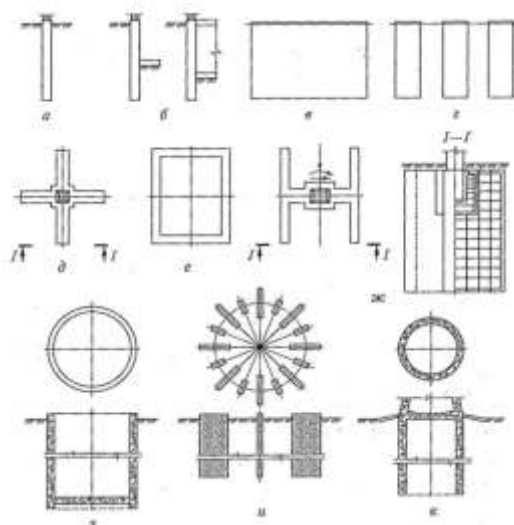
Шлицевые фундаменты: а-ленточный под стены; б,в-ленточные с подвалом; г-ленточные сплошные и прерывистые; д-под колонну крестообразные; е-прямоугольные; ж-под колонну тавровой или двутавровой формы; з-круглых в плане сооружений-опускного колодца; и,к-дымовых труб (радиальные шлицы и кольцевой фундамент)
